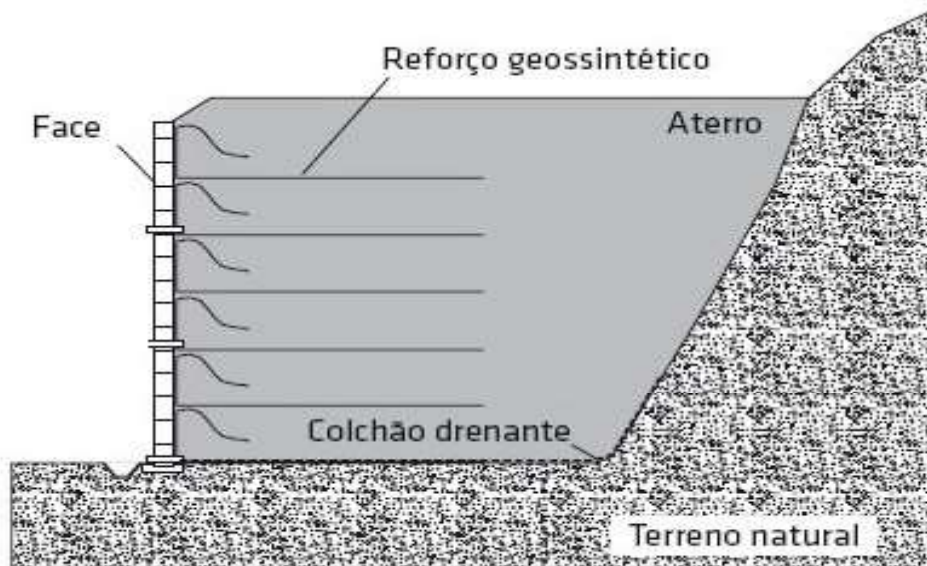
Seção transversal típica de um muro de solo reforçado com geossintético com face em blocos de concreto (Palmeira, 2018).
